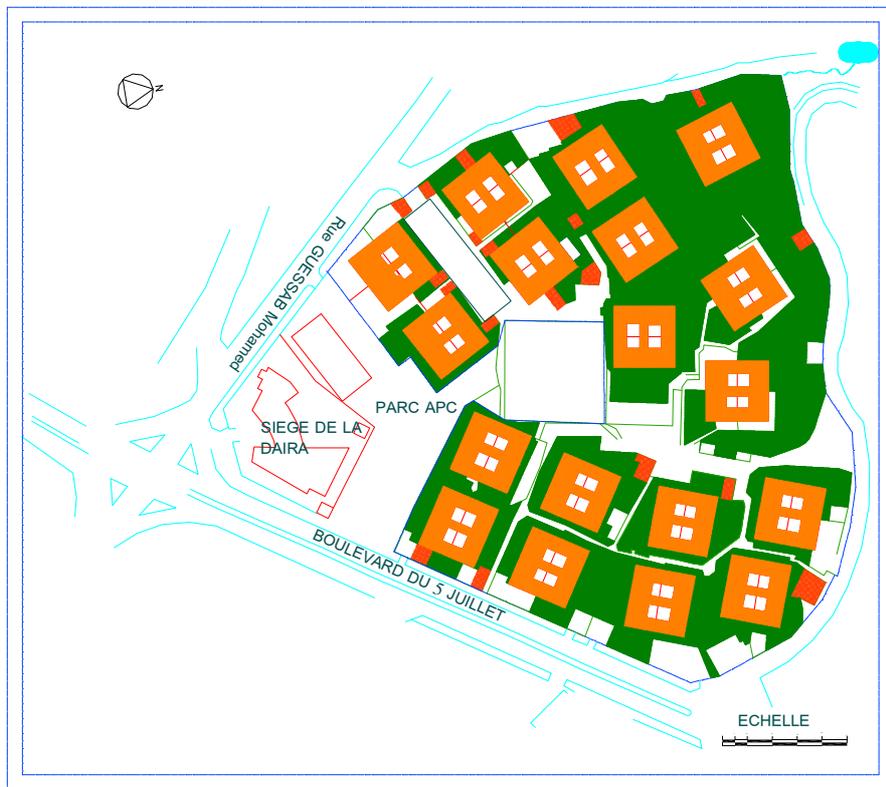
Plan de repérage des espaces à usage de verdure. Zone 02.
